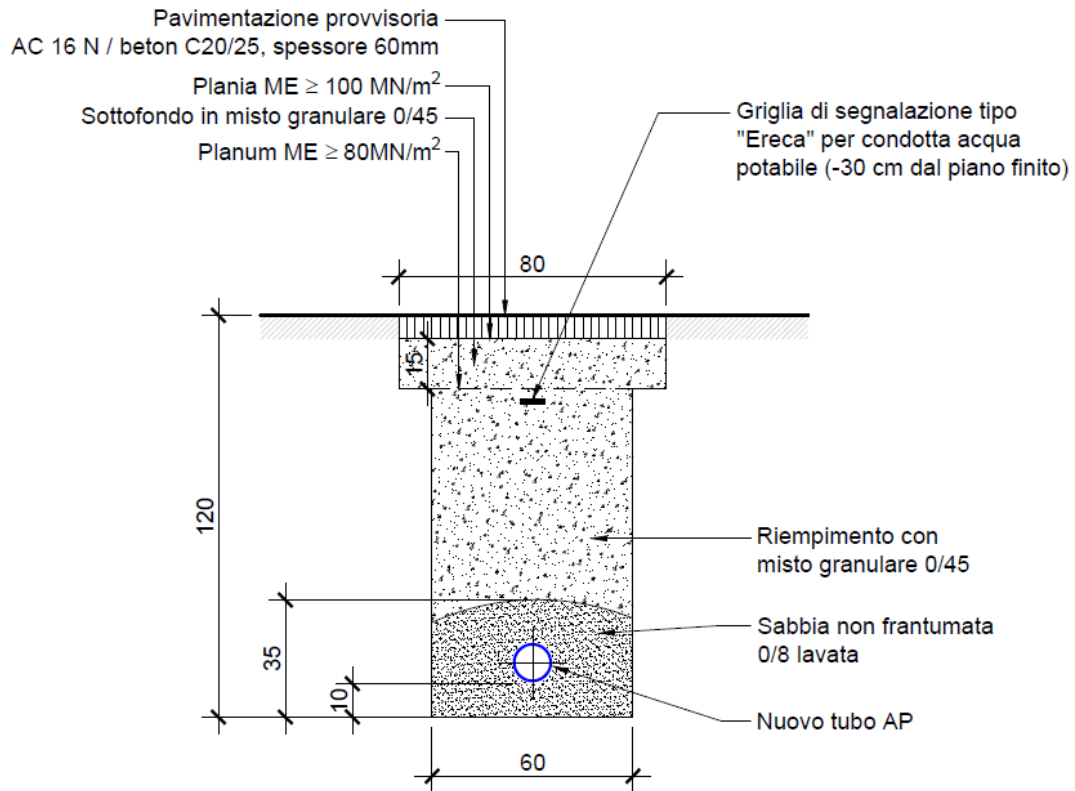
Sezione tipo trincea di posa della condotta, pavimentazione provvisoria
